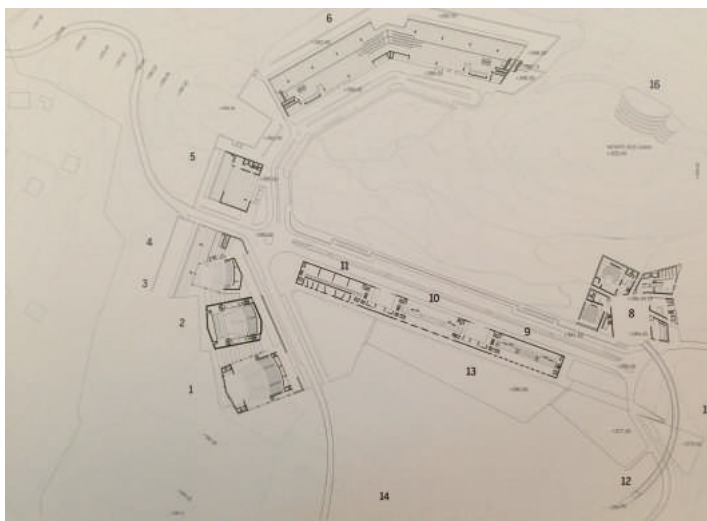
Juan Navarro Baldeweg, Planta del conjunto.
